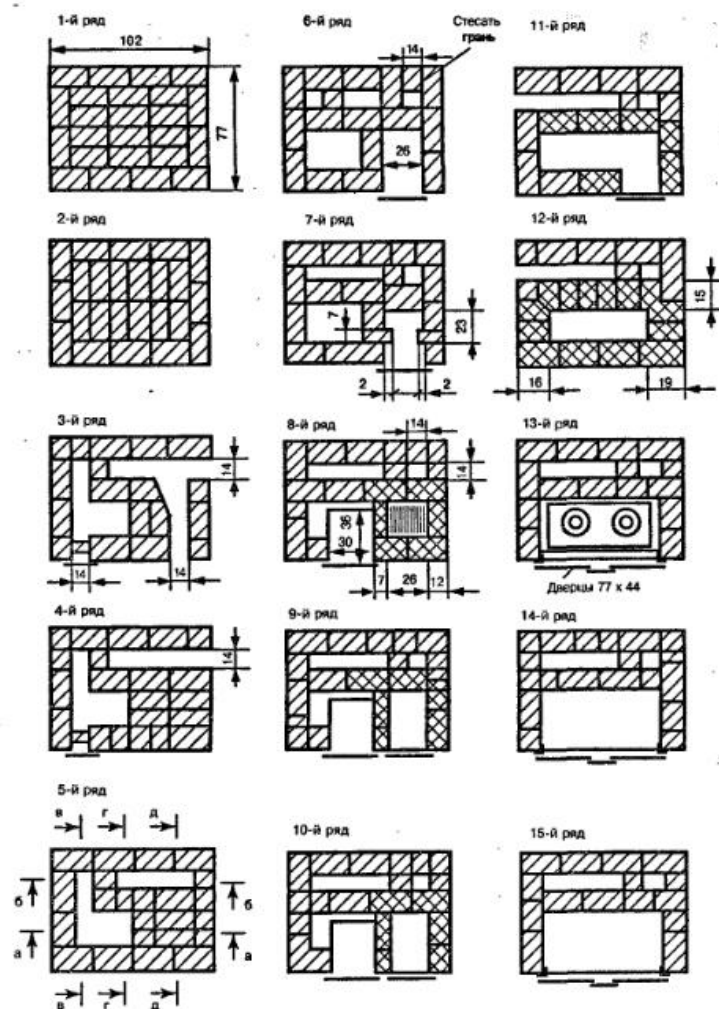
Порядовки печи ИП-2 (с духовкой). Размеры в см
